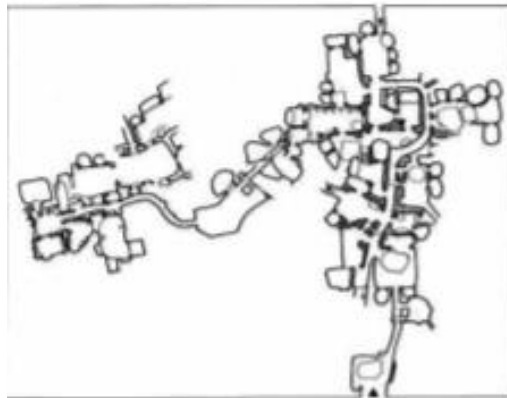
Planta parcial de ciudad subterránea Kaymakli Capadocia. Turquía
